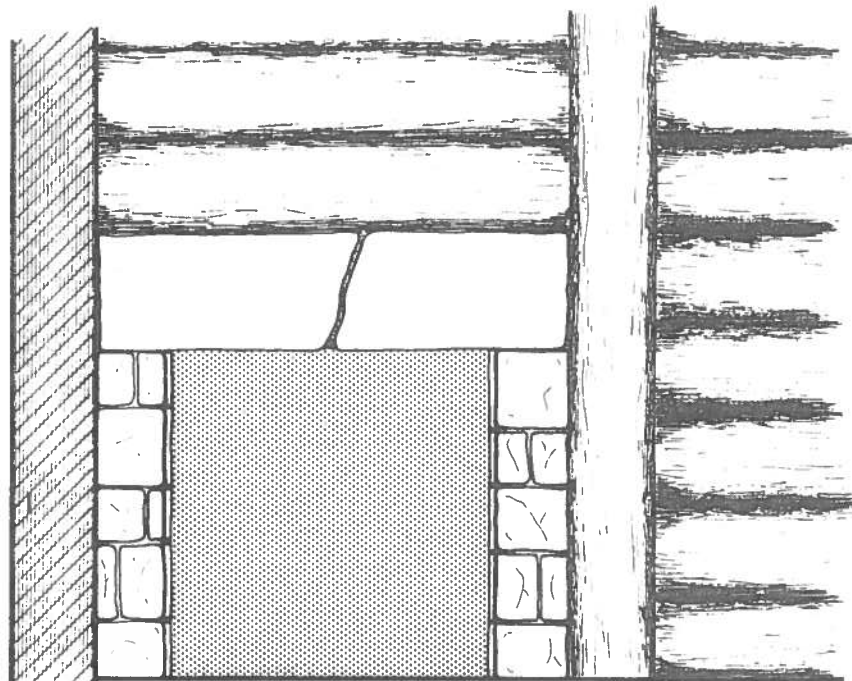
Disposition du manteau de la cheminée de la baraque 11.4; plan et élévation. (Dessin: François Pellerin; 82-25G7-5)
